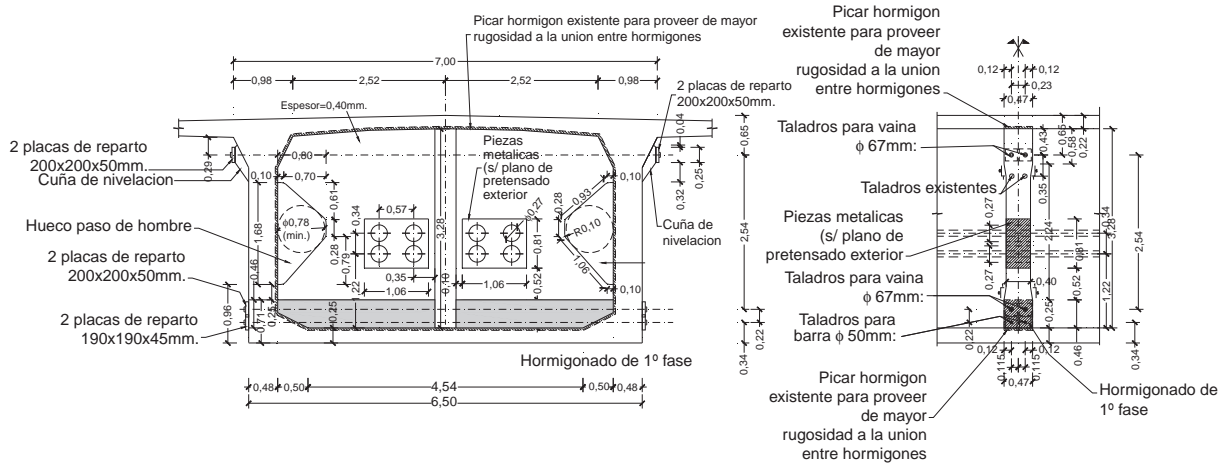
Alzado y sección transversal de los desviadores-rigidizadores (no se representa el cajón metálico).
